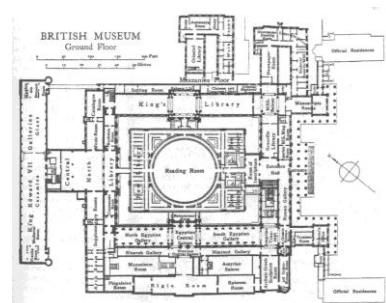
British Museum, Londres, 1852, Reading Room construída em 1857; Robert Smirke (Planta piso térreo)
